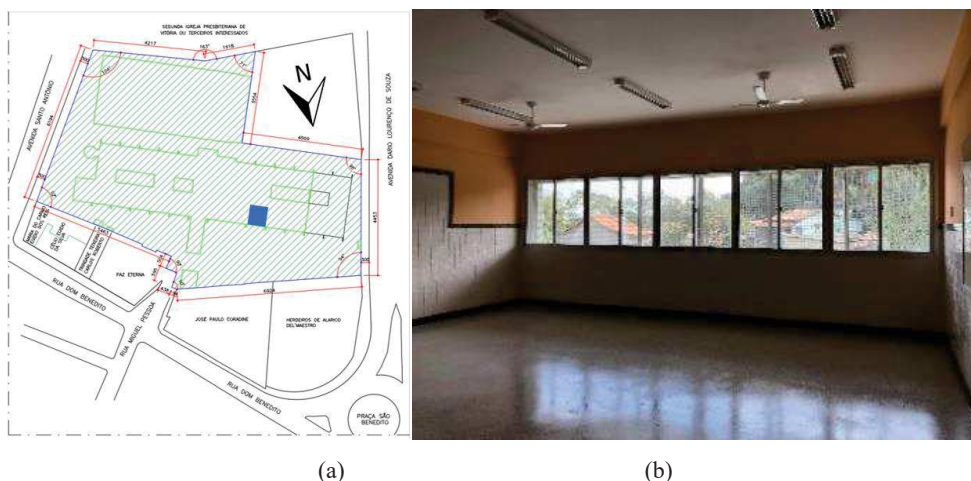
(a) Planta de situação com demarcação do ambiente analisado (2º pav.). (b) Imagem do ambiente analisado.
